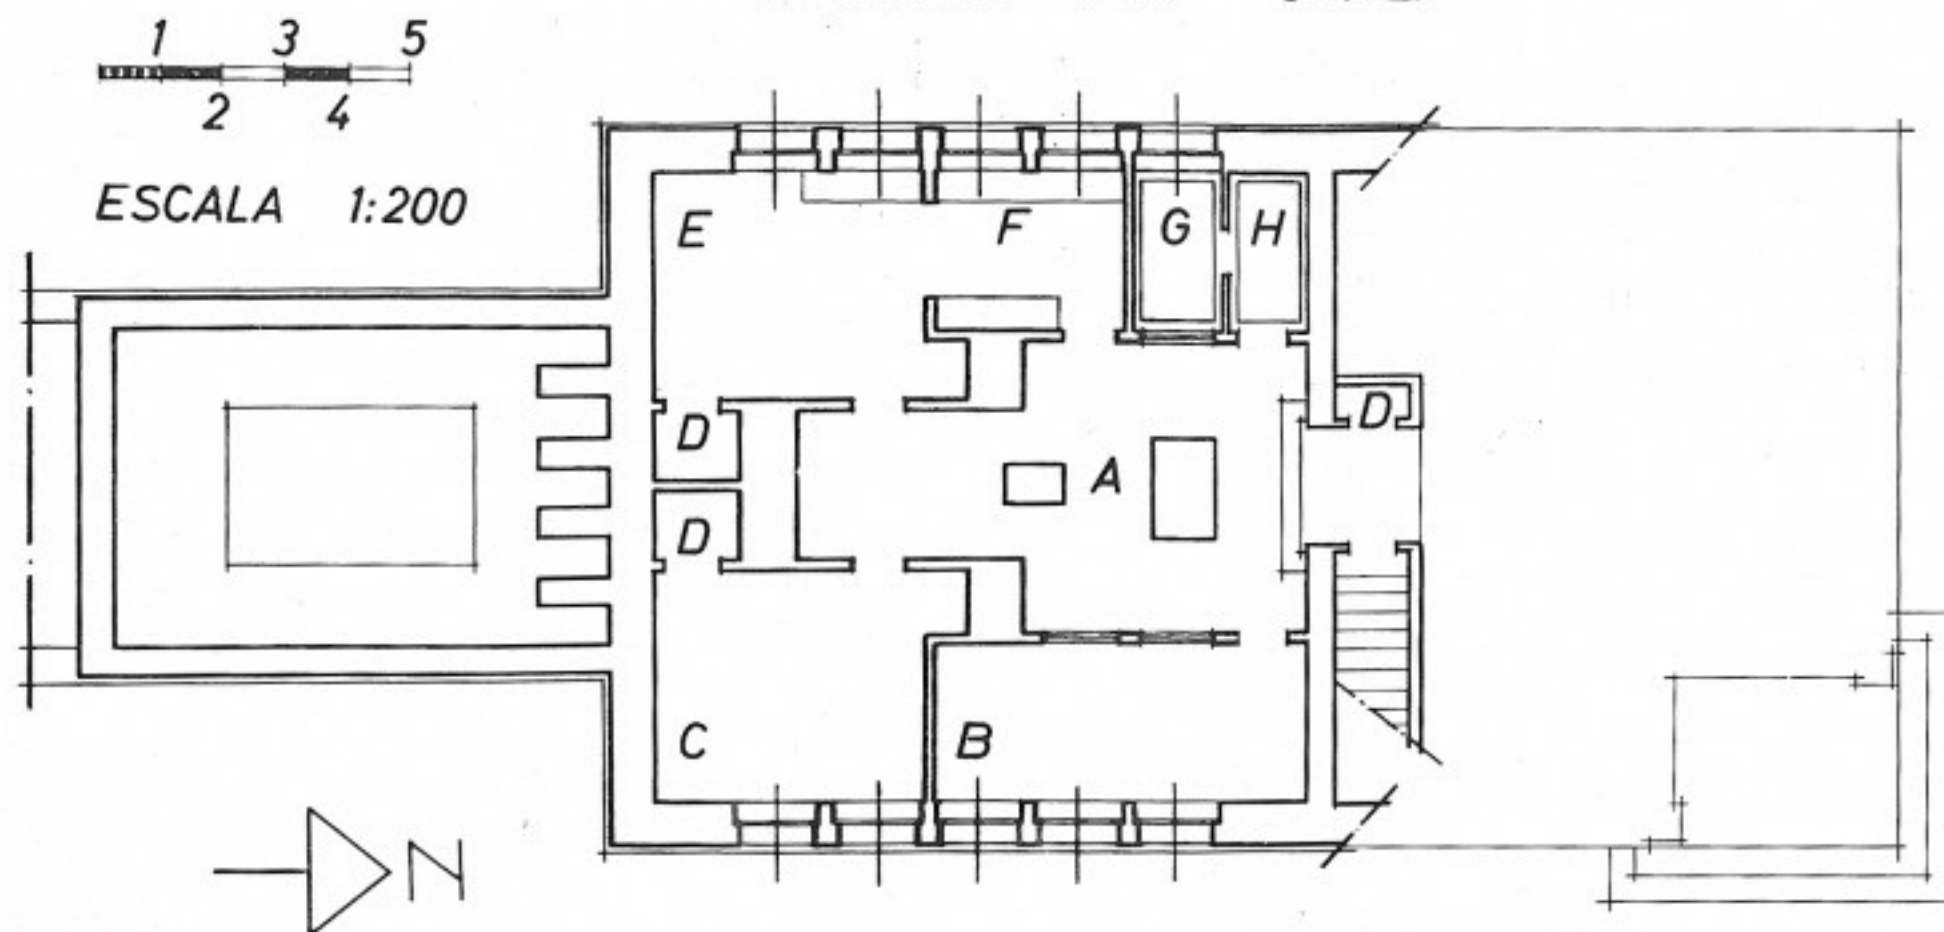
Planta da cave do pavilhão do espectroheliógrafo (escala 1:200).
